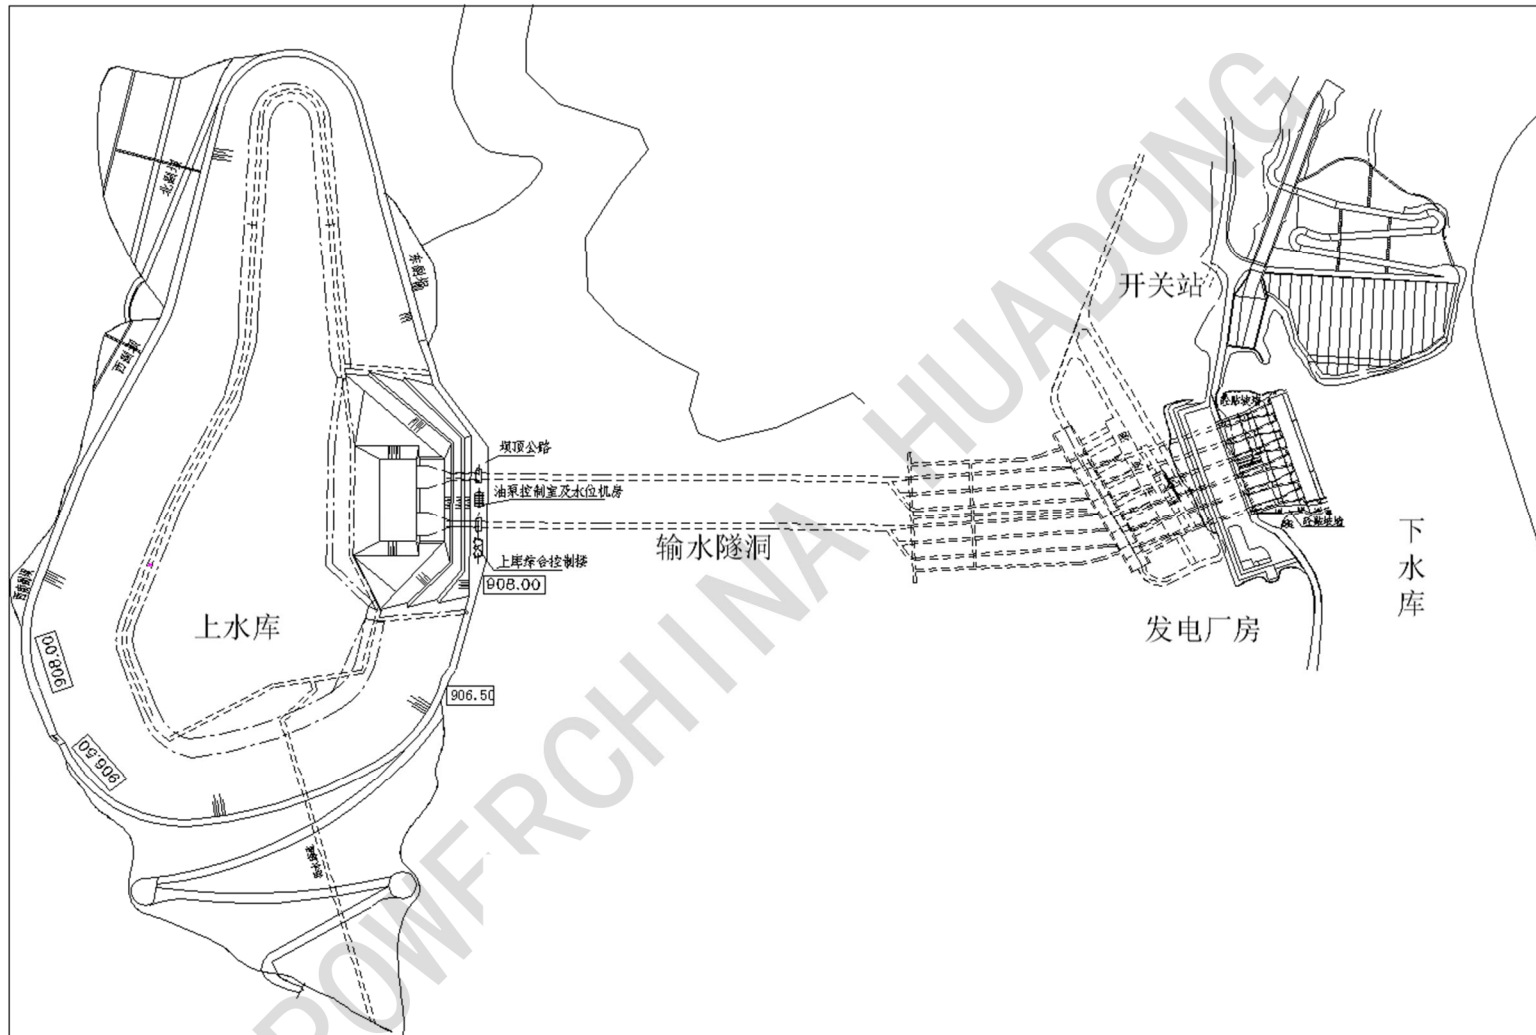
天荒坪抽水蓄能电站枢纽平面布置
